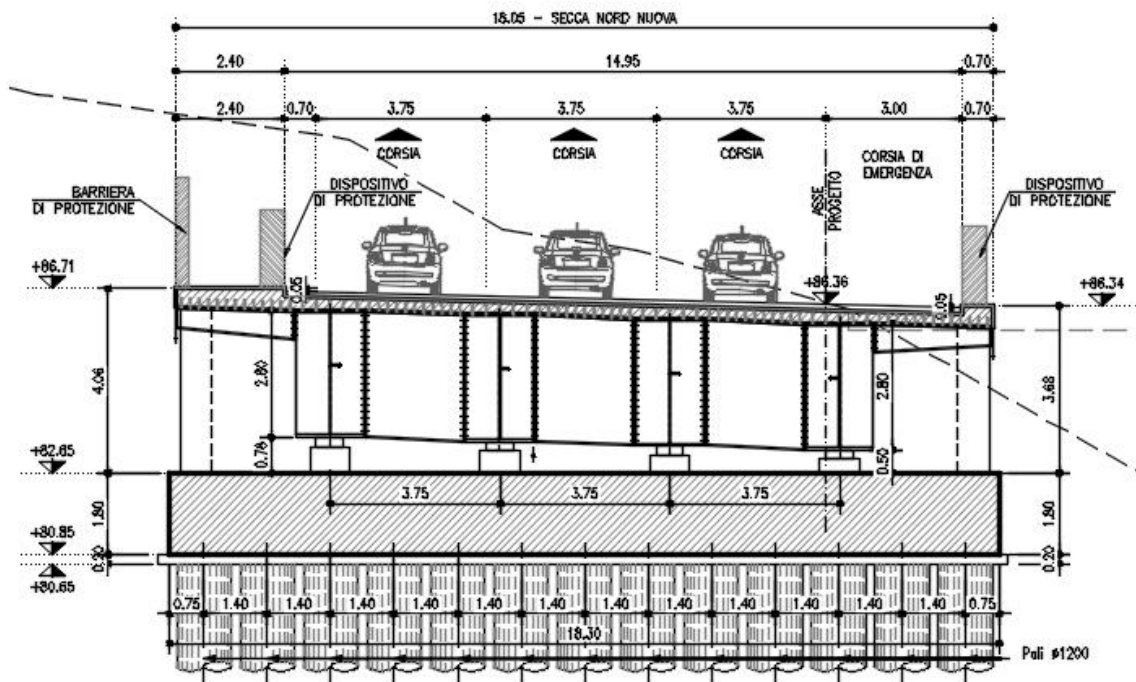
Struttura impalcato - Sezione trasversale tipo 1 (sezione su spalla SpA)
